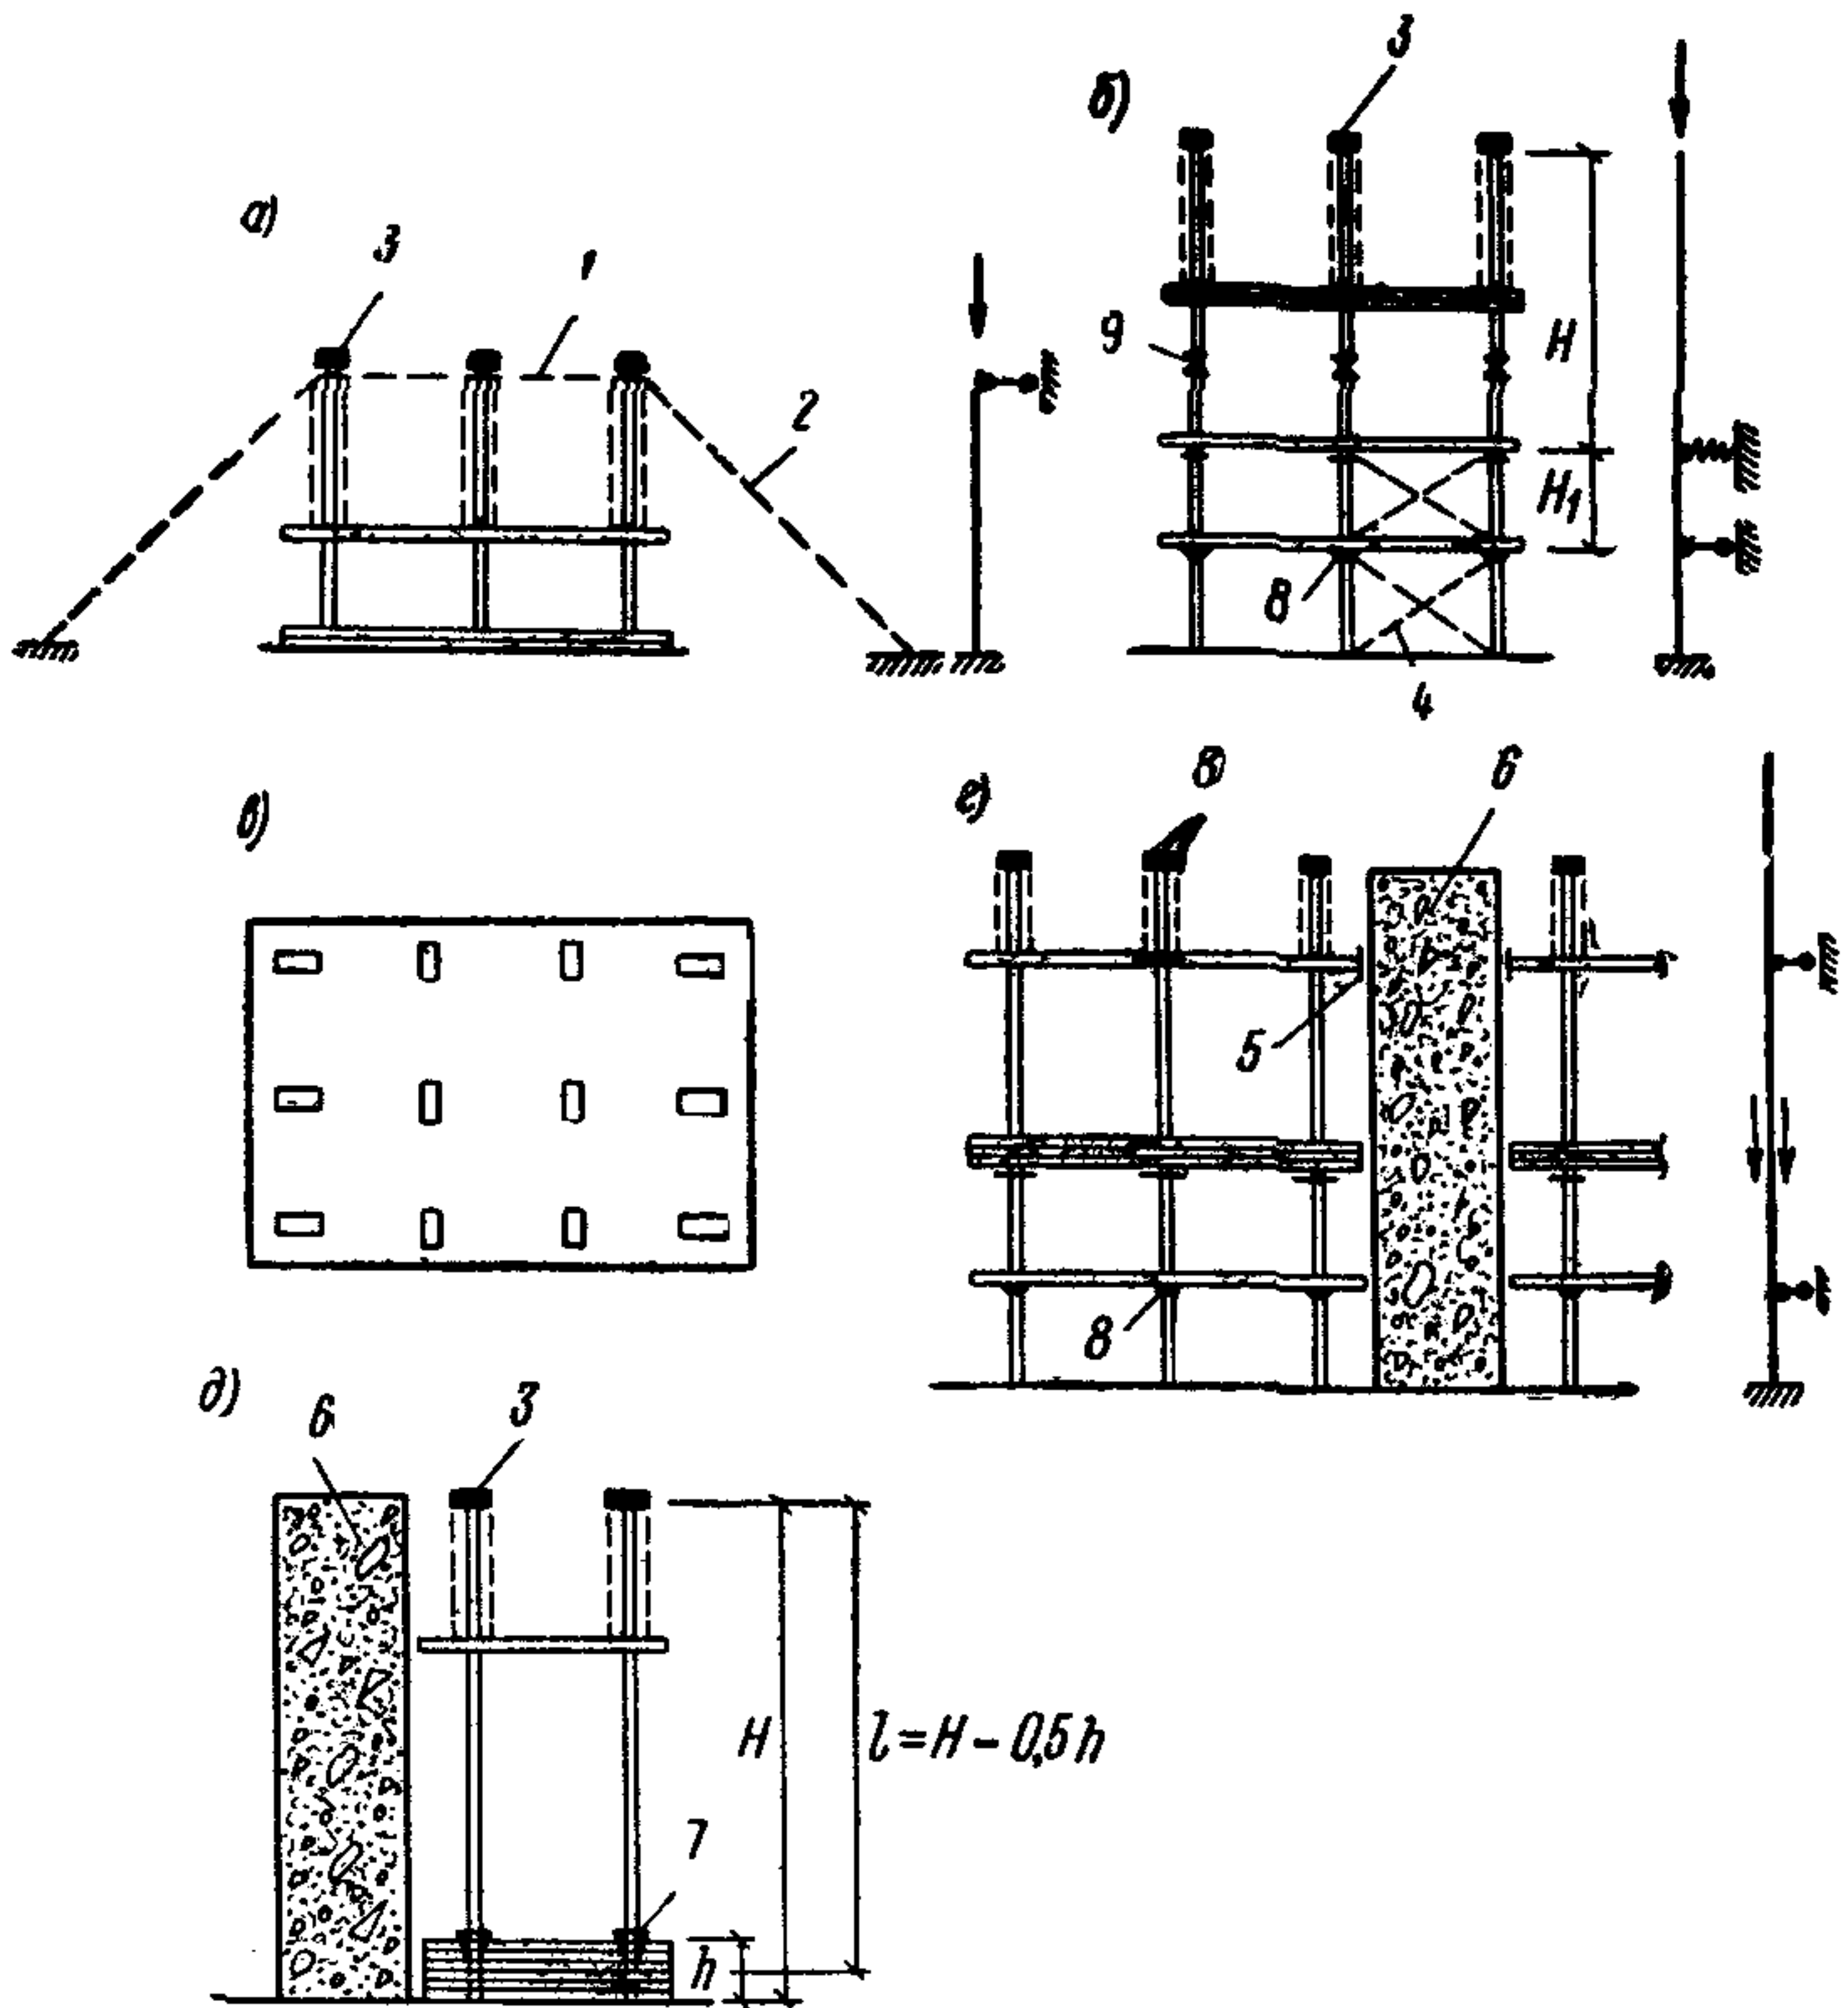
Приемы повышения устойчивости каркаса здания на период монтажа
